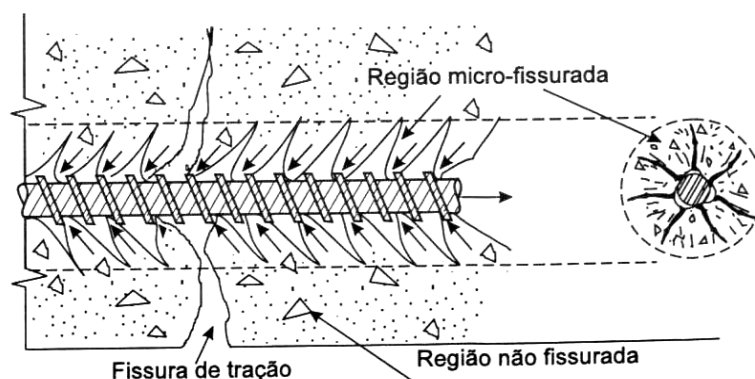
Deformação do concreto após a formação de micro-fissuras (GOTO, 1971).
